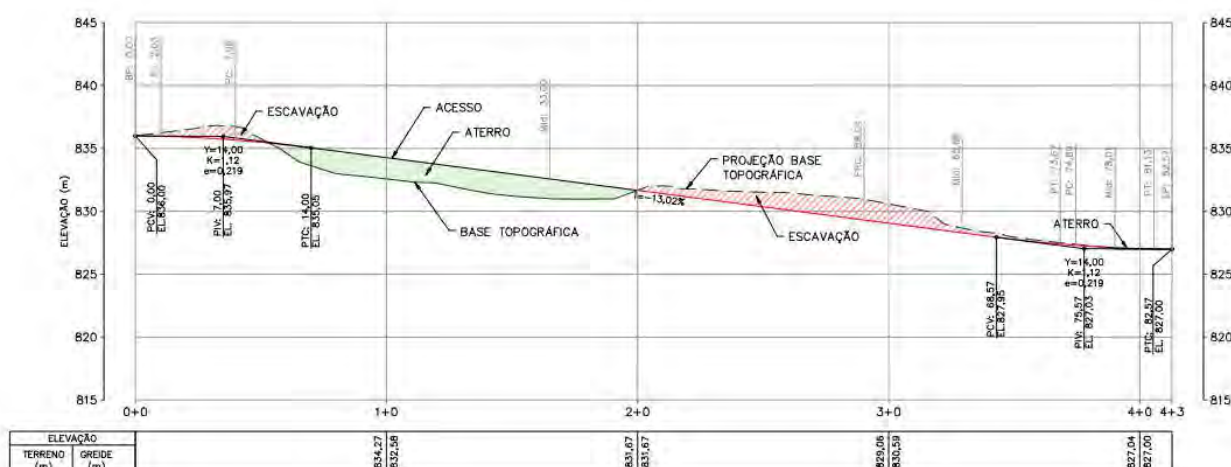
Acesso Construtivo – Perfil longitudinal (Fonte: 1850JJ-X-31343 – BVP)
